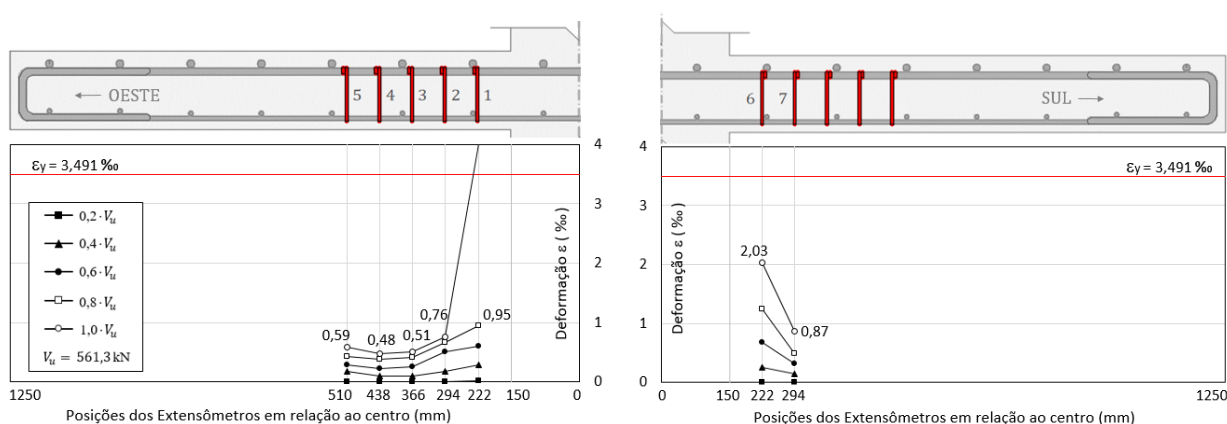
Deformações nas armaduras de cisalhamento da laje FA-05
